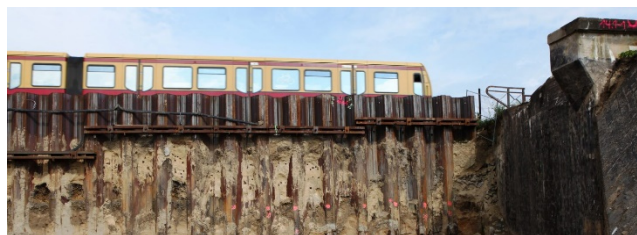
Scénario : Passage d'une voie ferroviaire en tête de la palplanche
